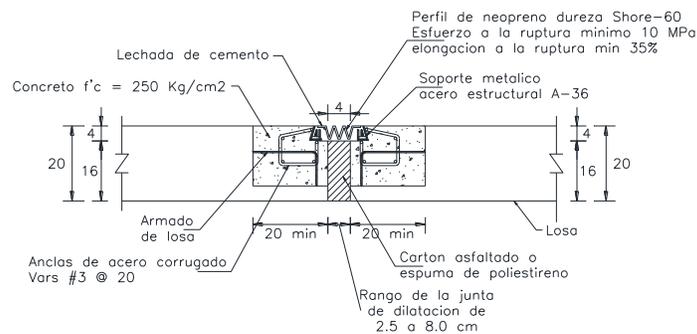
Detalle de junta de calzada tipo MEX-T-50 en pila.
